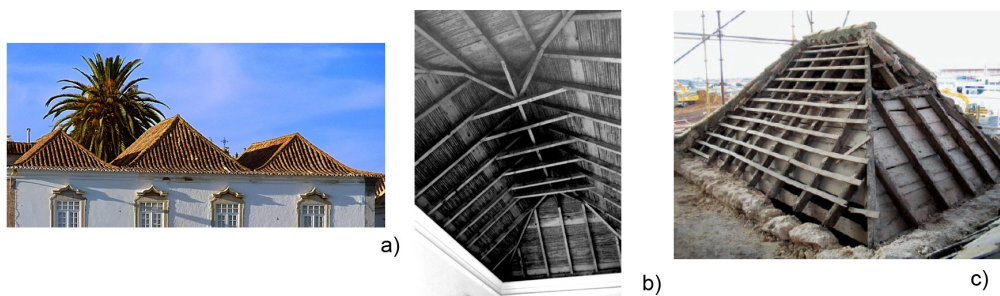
Telhados de tesouro: a) vista exterior (foto de autor desconhecido); b) estrutura interior (Nascimento 2015); d) estrutura pelo exterior (Afonso 2006).
